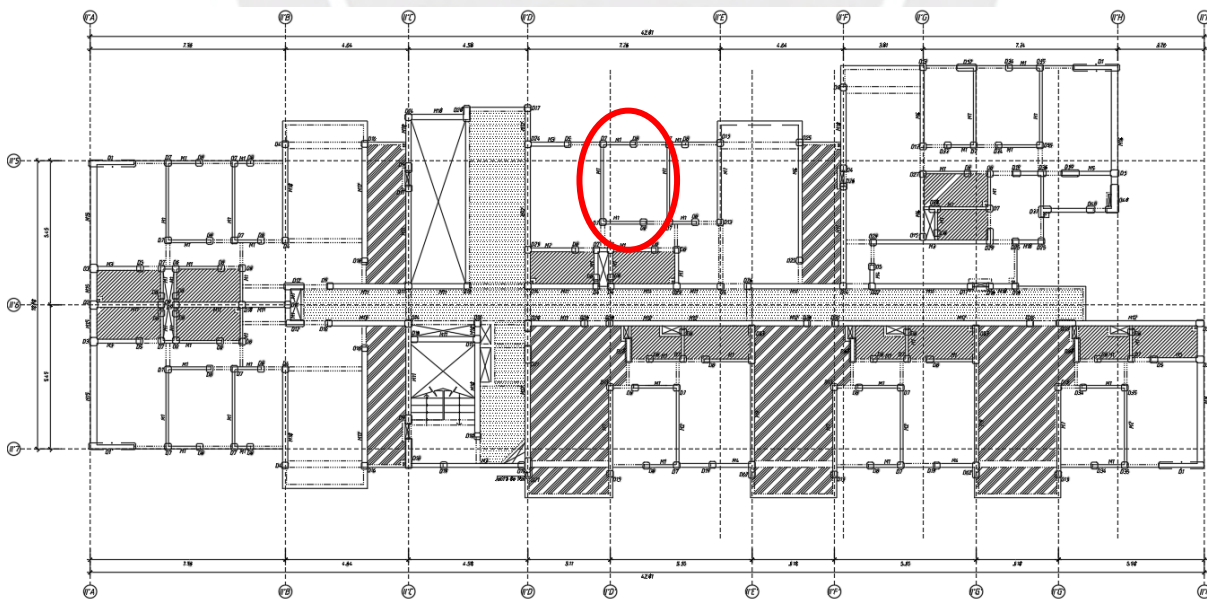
Ubicación de muro M1 a modelar en plano de encofrados
